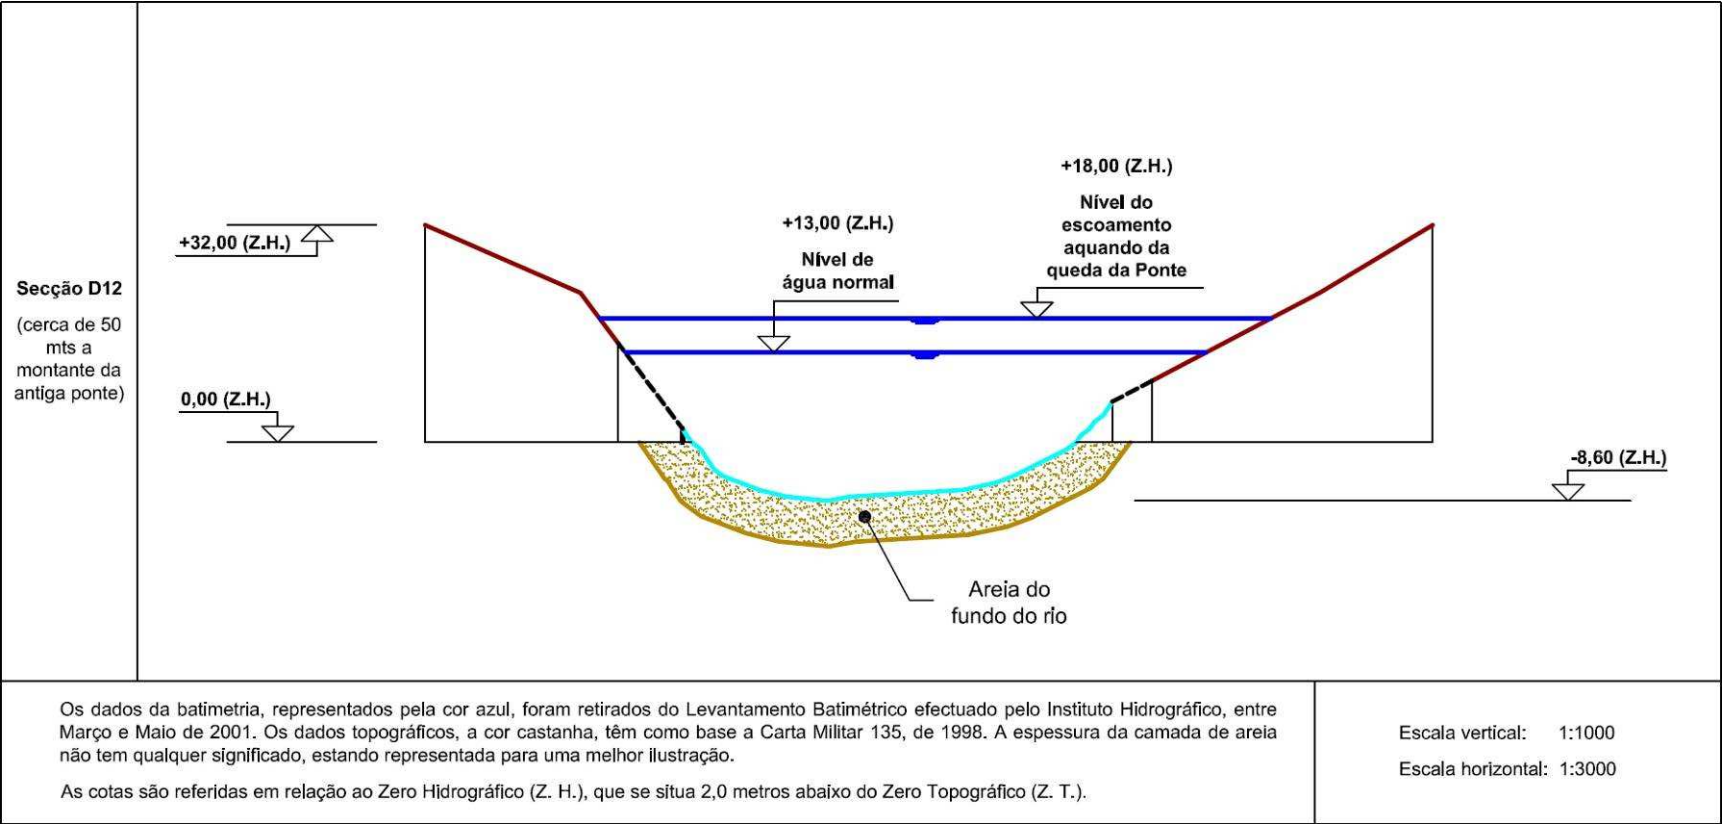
Exemplo de uma secção transversal situada 50 metros a montante da Antiga Ponte Hintze Ribeiro.
